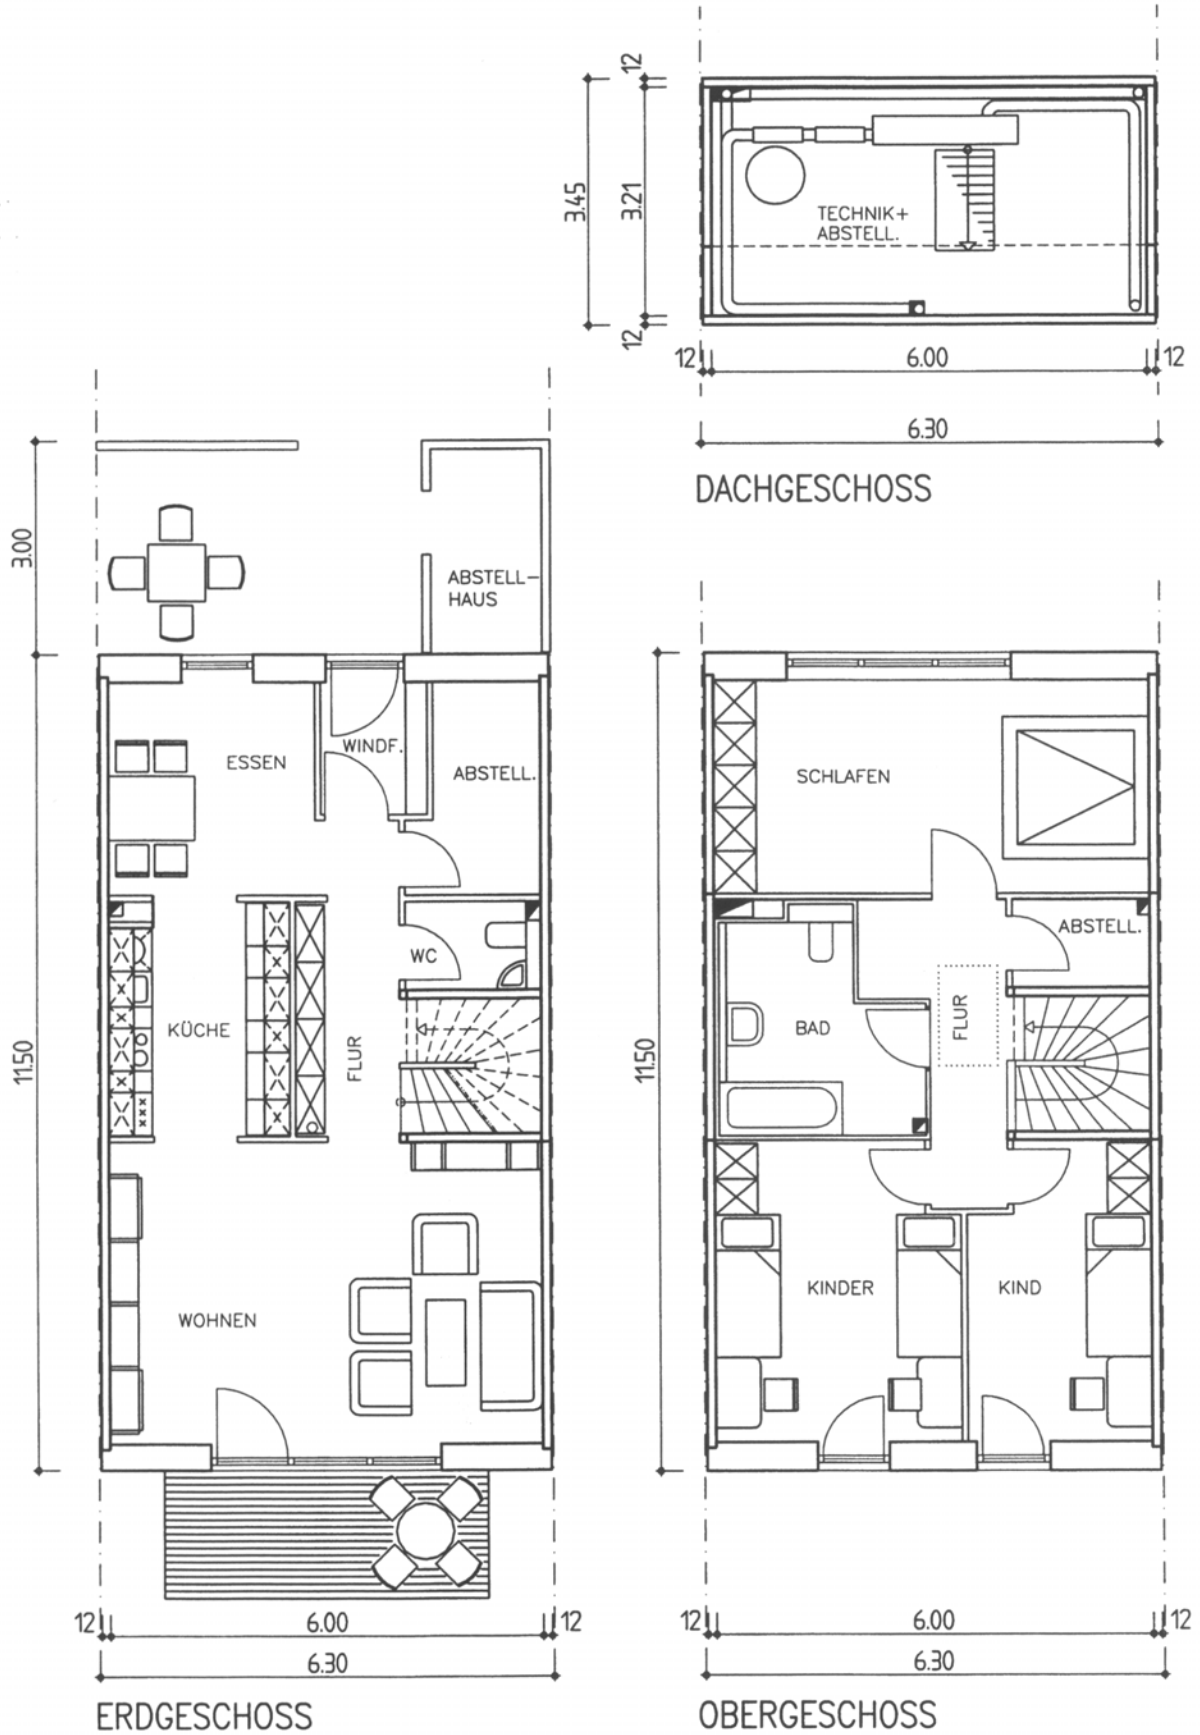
Grundrisse des Hauses vom Typ Jangster de Lüz (Passivhäuser Kronsberg)
